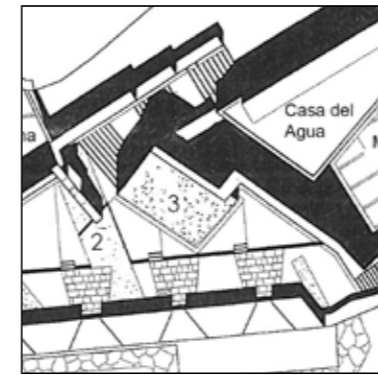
Planta del proyecto de restauración con la torre medieval descubierta, marcada con 3. (MJB 1996).
